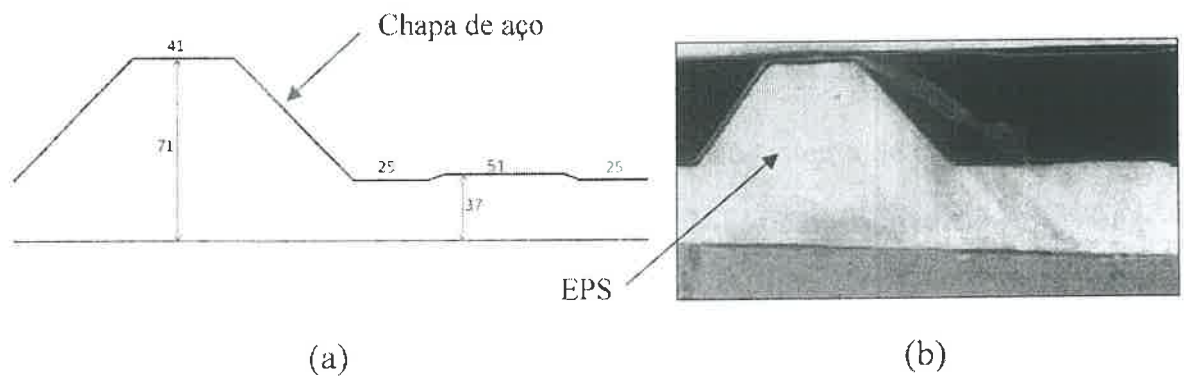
(a) Desenho e (b) Vista do tipo de telha sanduíche.
